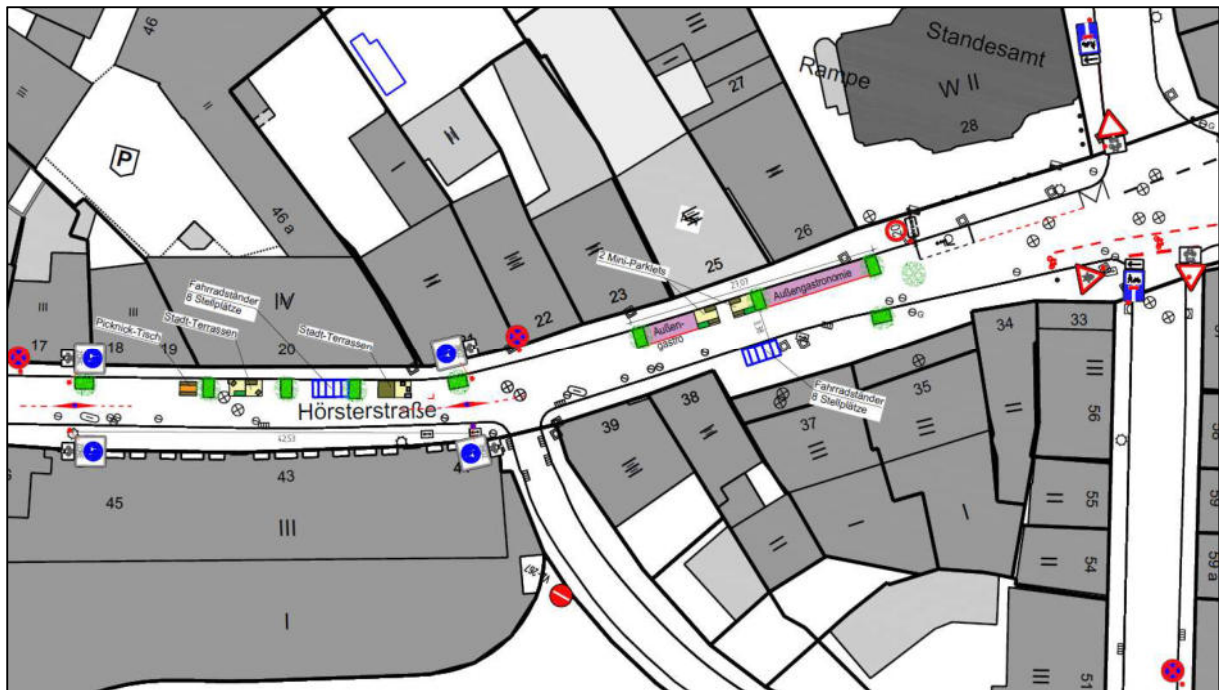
Lageplan zum Teilbereich Hörsterstraße-Ost im Verkehrsversuch (Stadt Münster)
